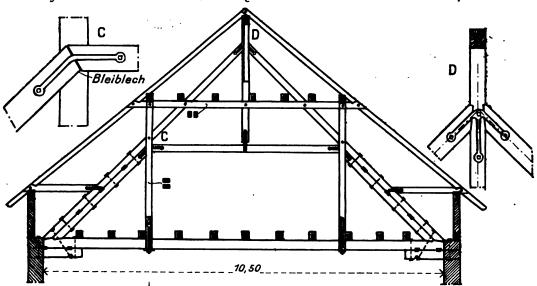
Dachstuhl mit zwei einfachen Hängewerken. M. 1:150.
